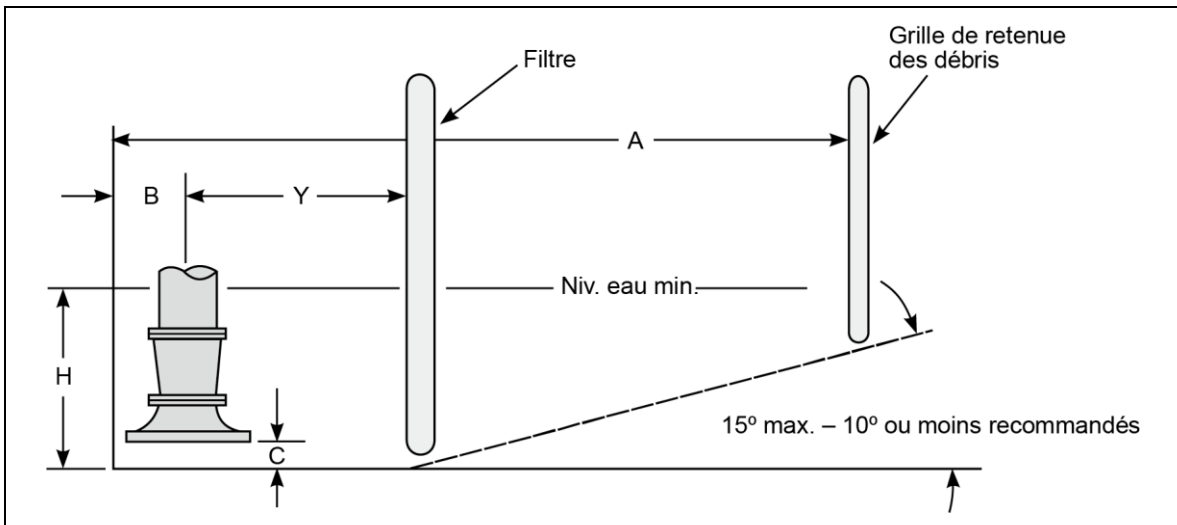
Dimensions du puisard, vue de face
